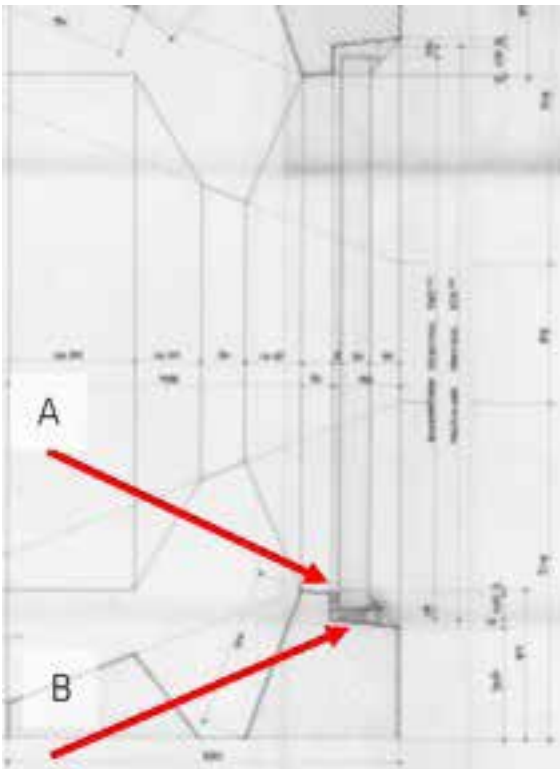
Planungsdetail Betonglasfenster (A Abschlussfuge teilweise ersetzt und nicht dichtend; B geplante Gefälleausbildung nicht vorhanden)¹².
